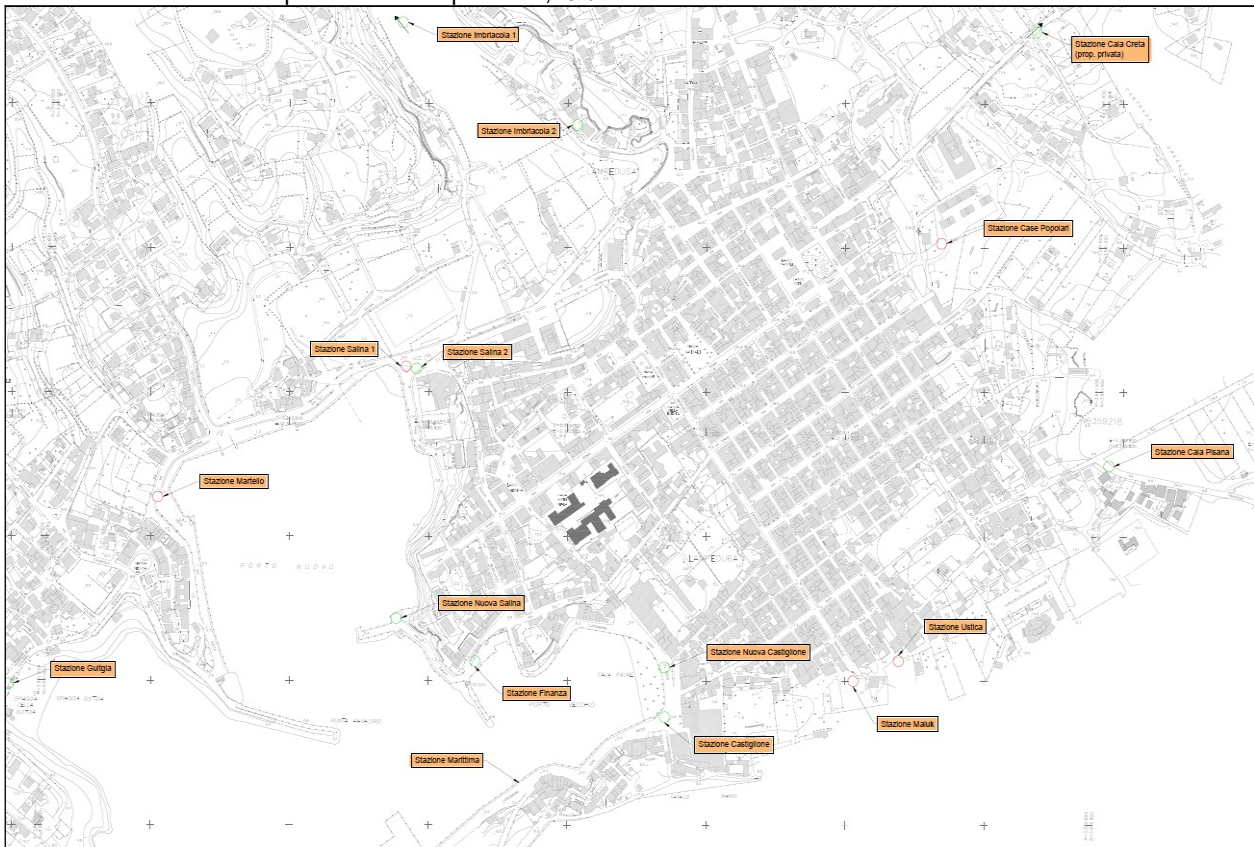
Planimetria Stazioni di Sollevamento Isola di Lampedusa
